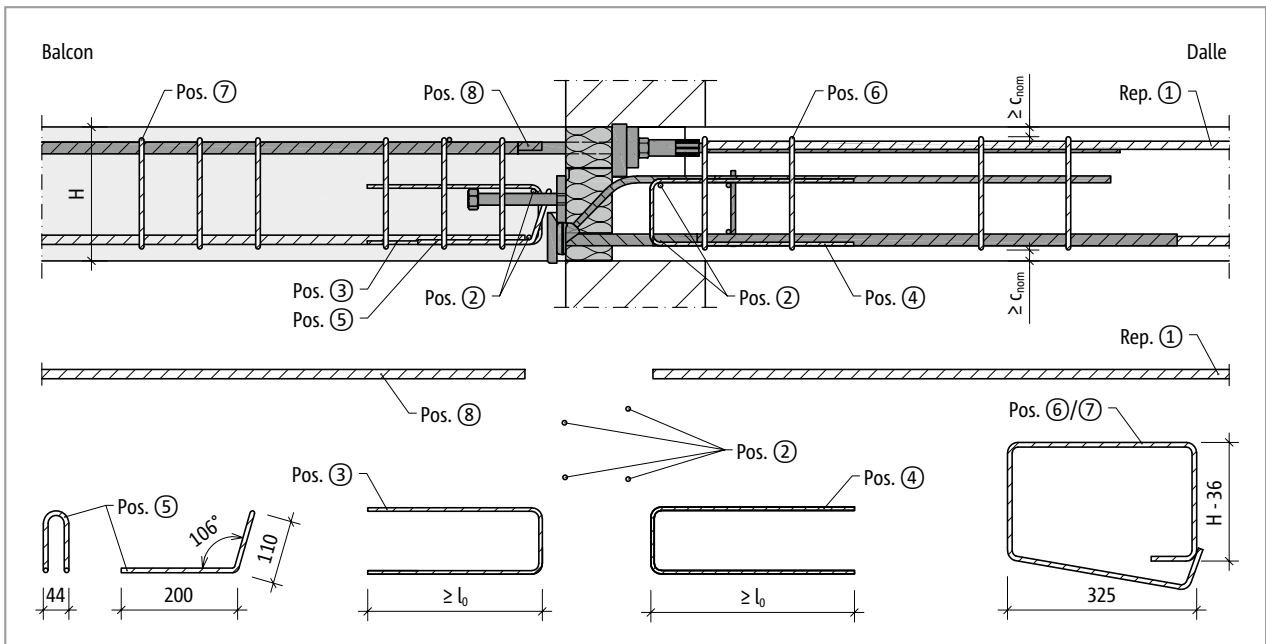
Schöck Isokorb® T type K-IQ-A-CB : armature sur site
